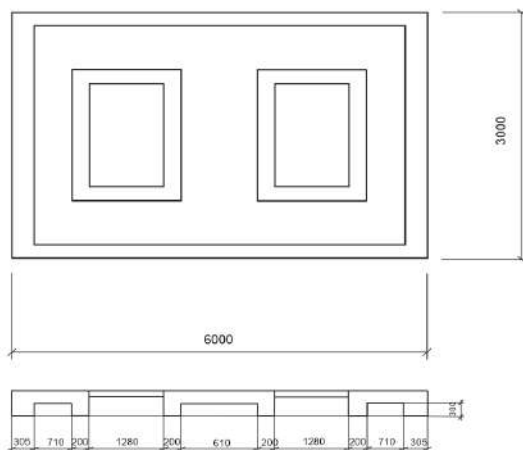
Фасад из стеновой панели серии 1.090.1-1
